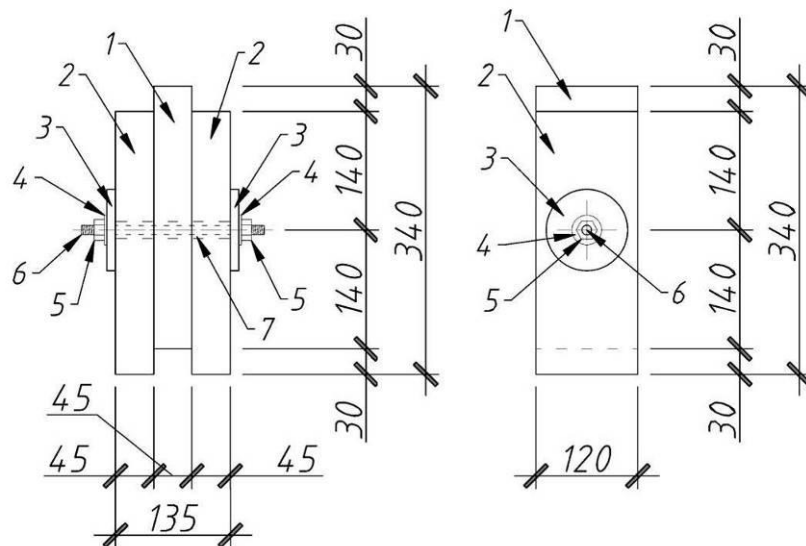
Схема образца для испытаний: 1 – центральный элемент; 2 – крайний элемент; 3 – траверса-шайба; 4 – кузовная шайба; 5 – гайка; 6 – винтовой стержень; 7 – зазор между стержнем и гнездом в древесине.
